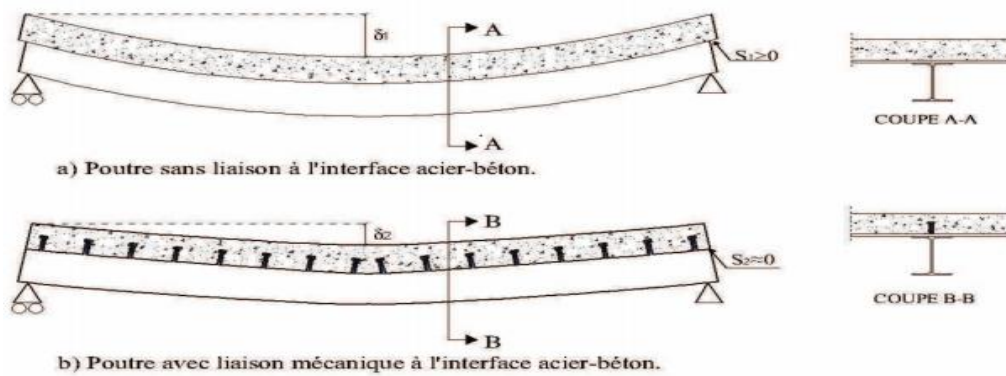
Principe de fonctionnement de poutre mixte fléchie.
